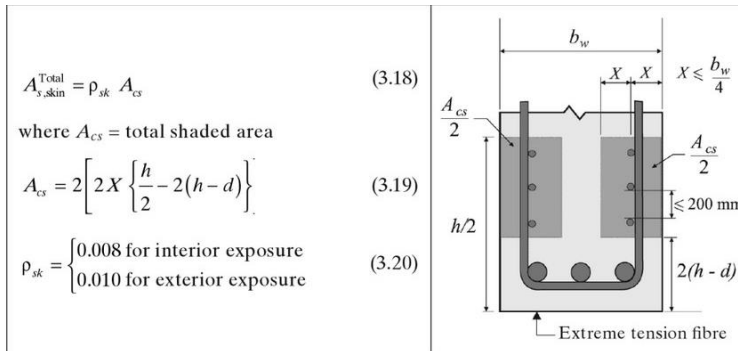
Berechnung der Oberflächenbewehrung nach CSA-A23.3
